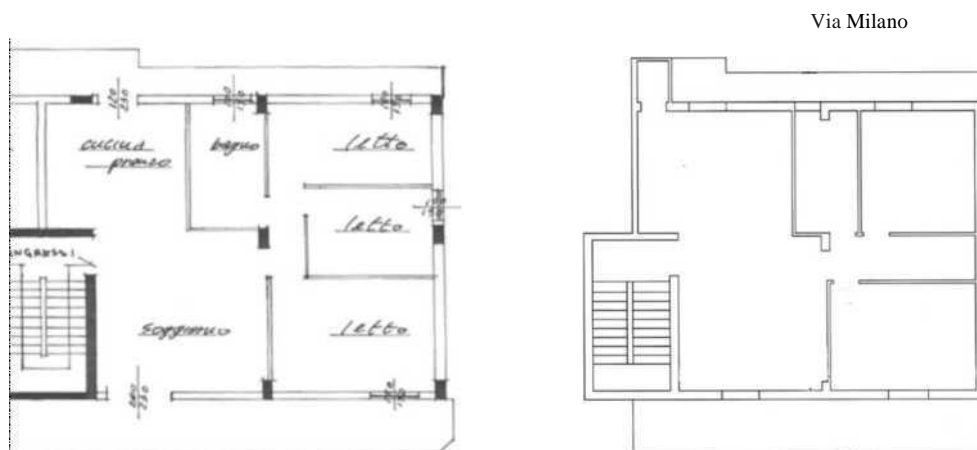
Appartamento piano terzo sub 11 - Confronto tra la planimetria "assentita" e stato di fatto.
